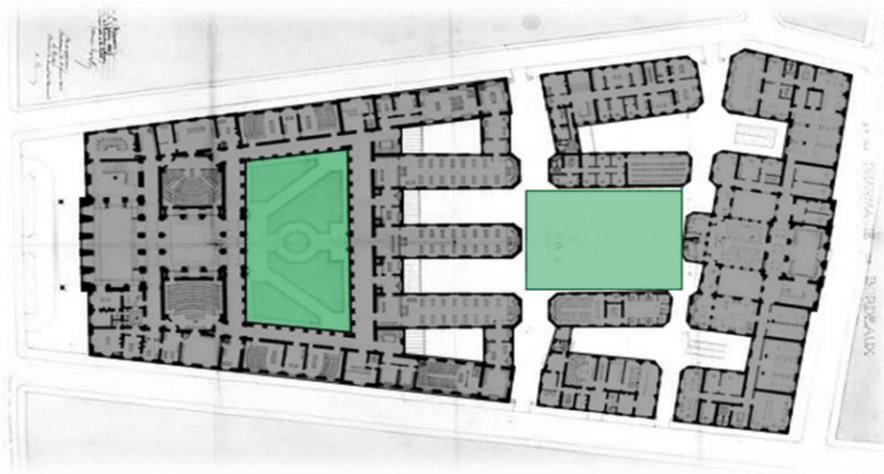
Plan architectural de la faculté de Bordeaux.
